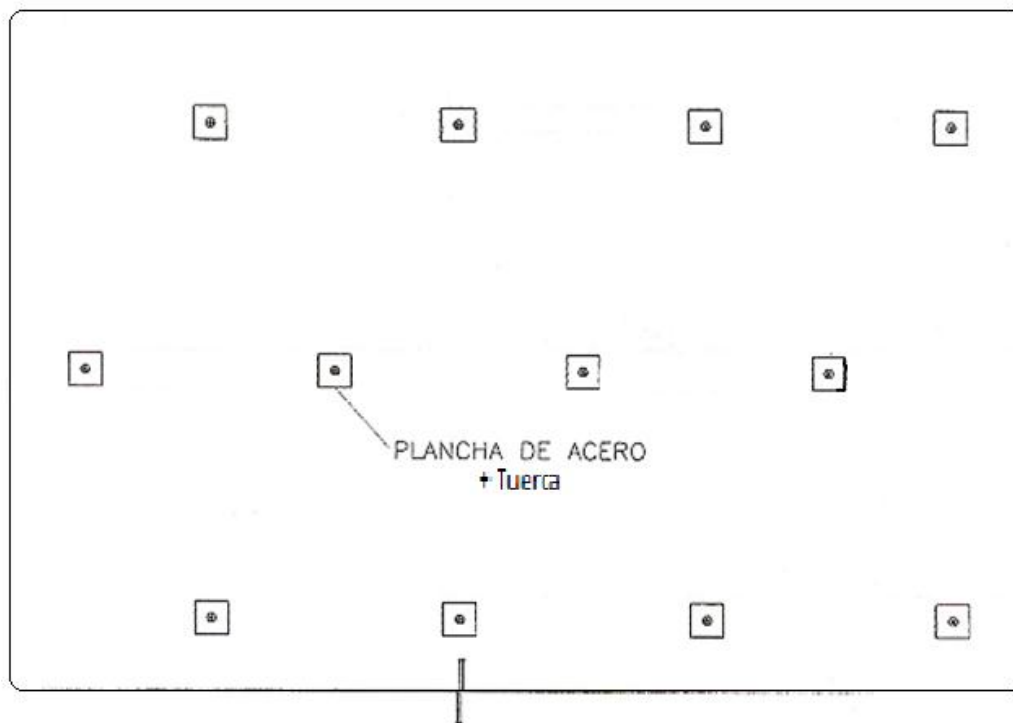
Vista frontal de la pantalla de concreto lanzado.
